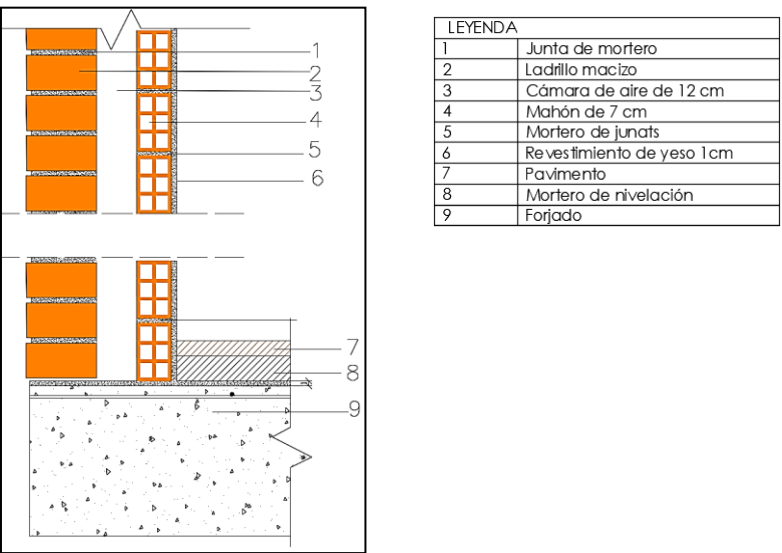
Detalle del encuentro de la fachada y forjado del edificio
